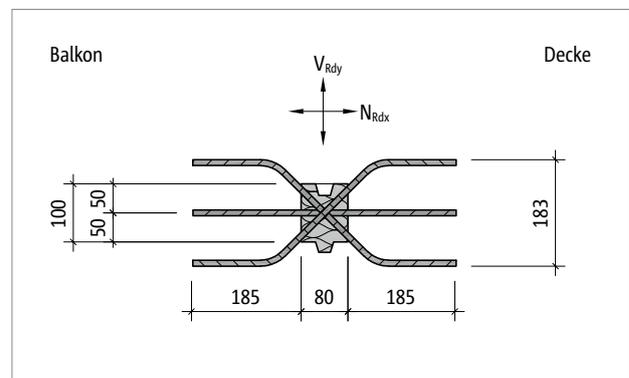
Schöck Isokorb® T Typ HP-VV1-NN1: Produktgrundriss
